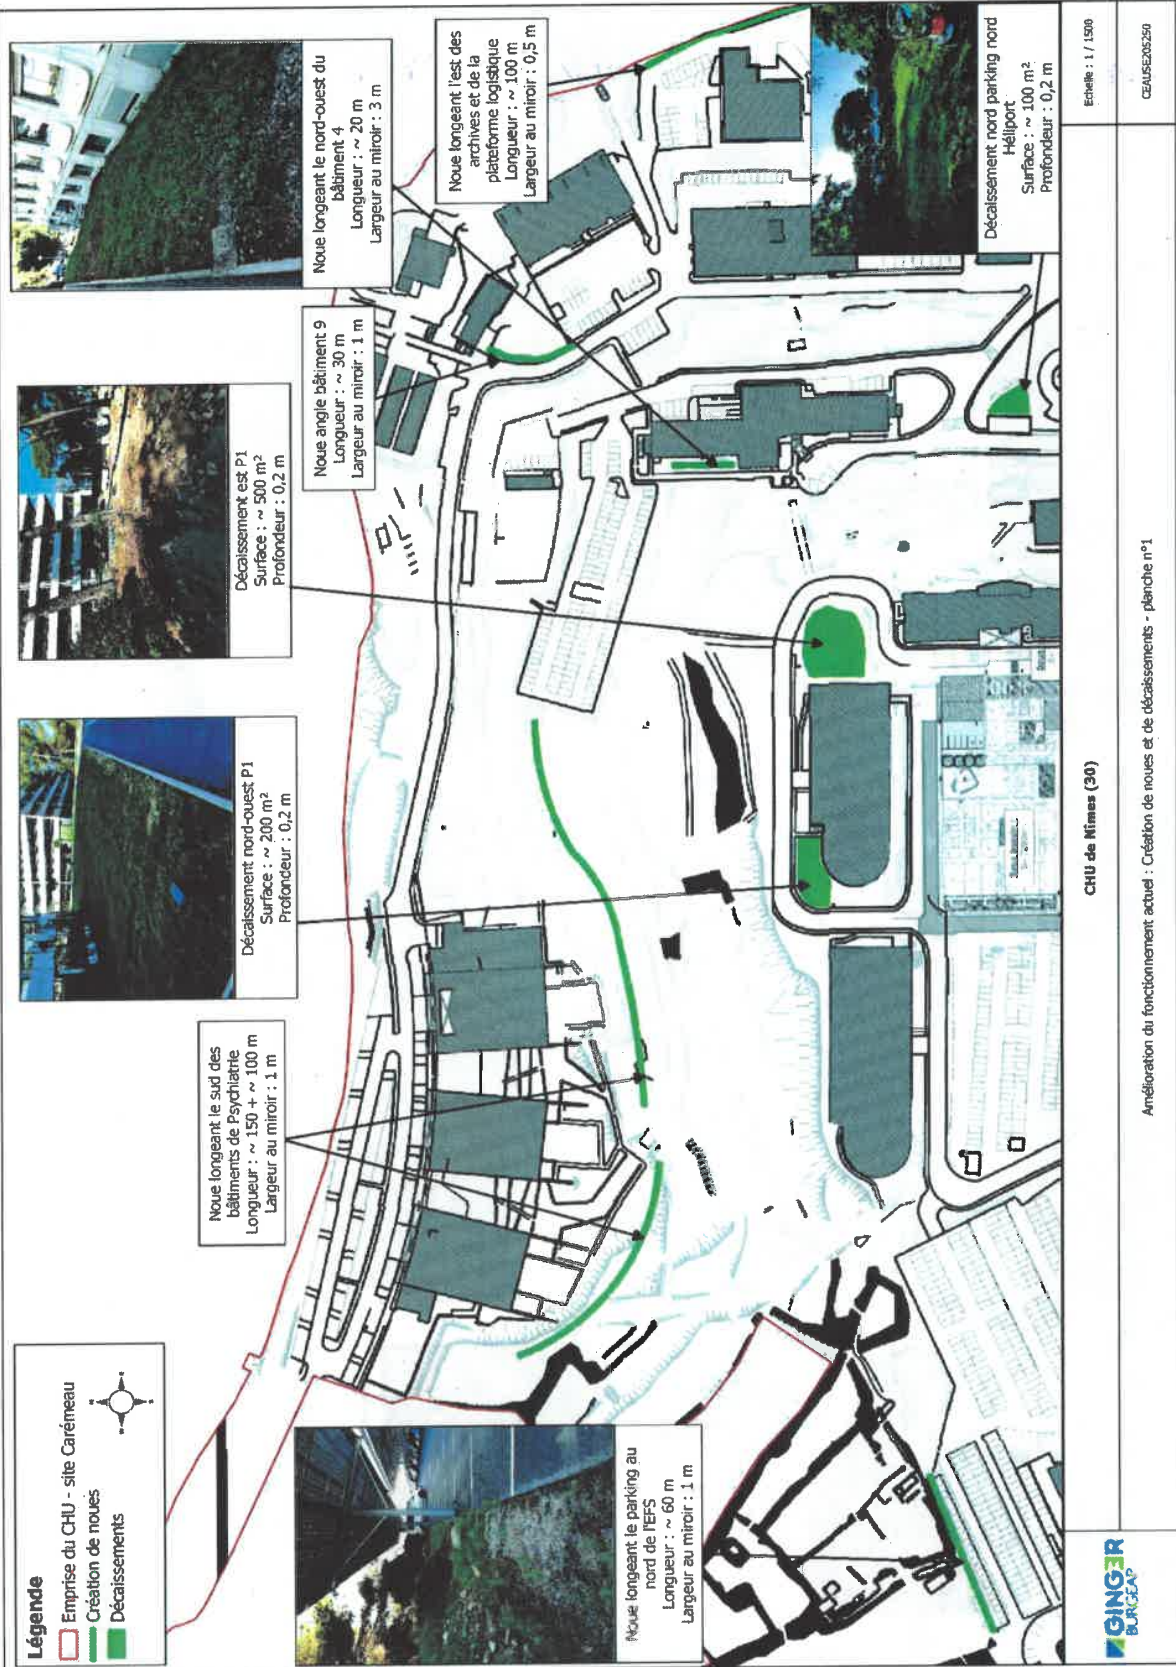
Amélioration du fonctionnement actuel, création de noues et de décaissements, planche n°1 (source : GINGER BURGEAP sur plan de masse du CHU)
